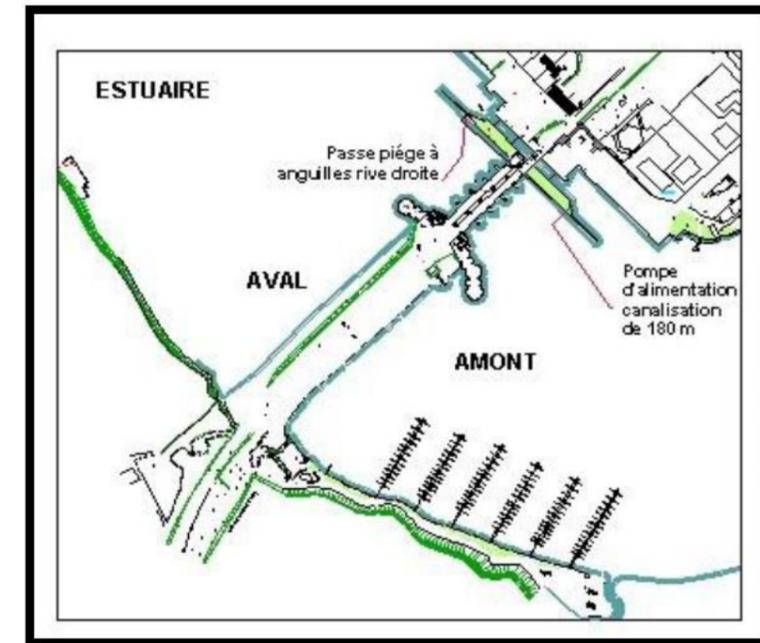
Localisation de la passe à anguilles construite en 2006 sur le barrage d'Arzal, au droit de l'écluse – Source : Eaux&Vilaine
